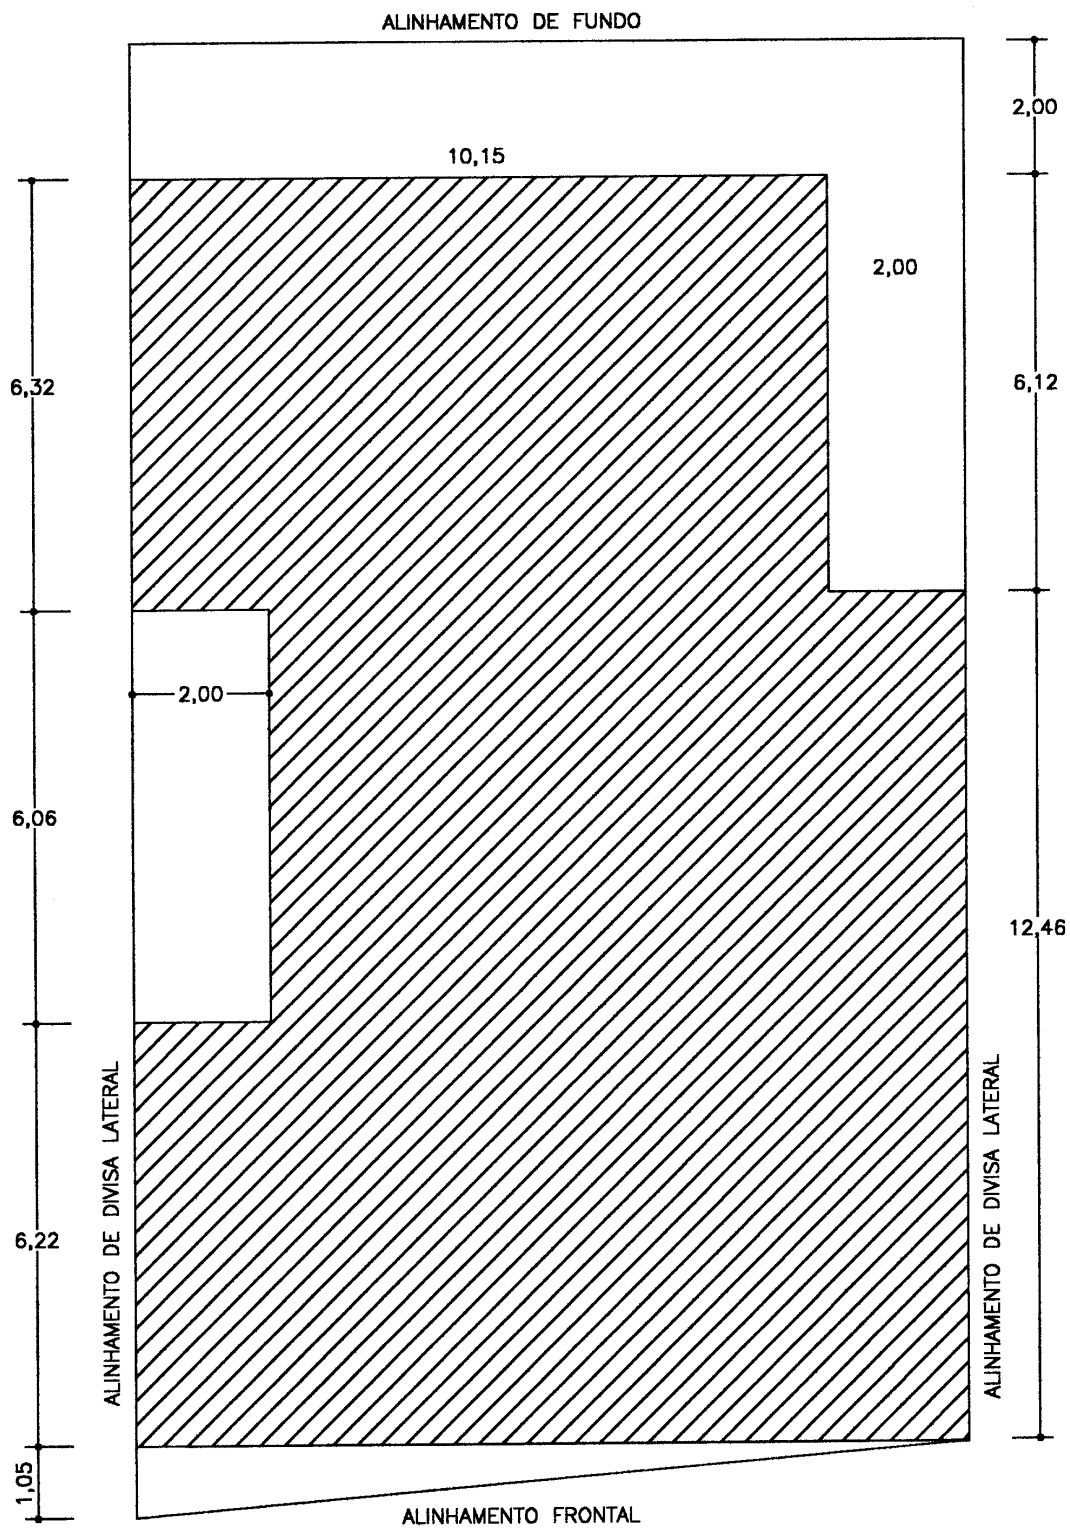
Planta de Implantação do Projeto no Terreno
